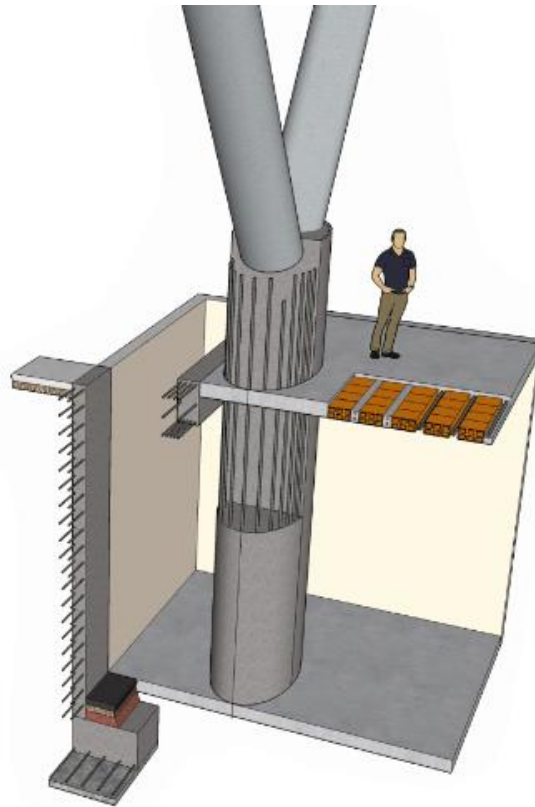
Detalle de base de hormigón armado. Fuente propia.
